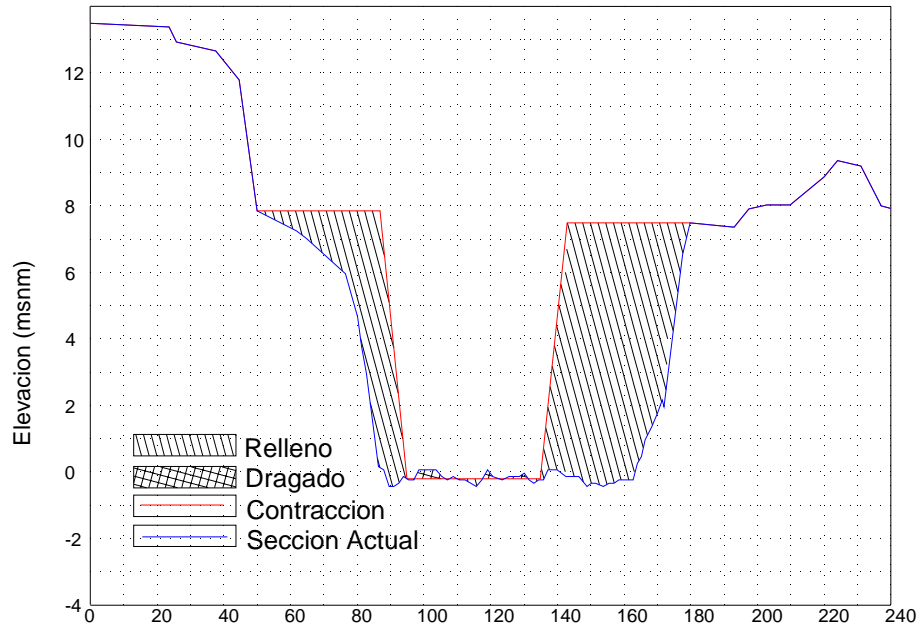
Sección transversal km 5 - Contracción No. 1
